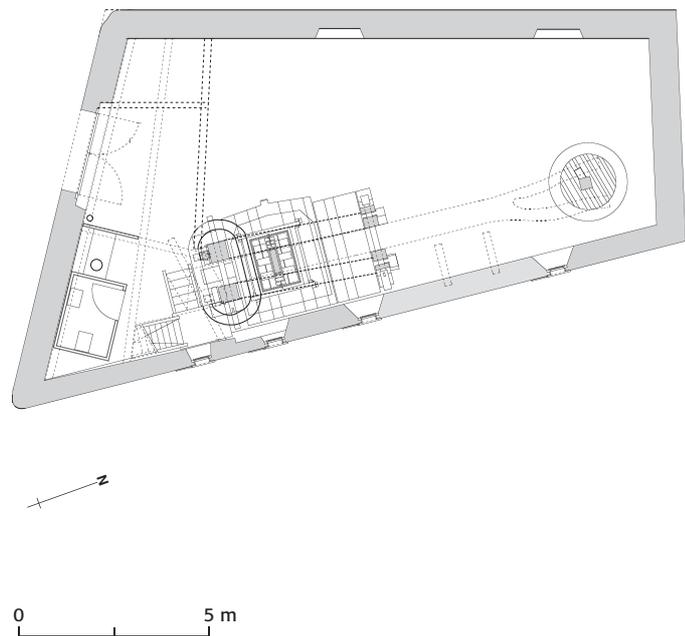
Maienfeld, Haus Nr. 234 (Eggtorkel). Grundriss Erdgeschoss. Mst. 1:200.
